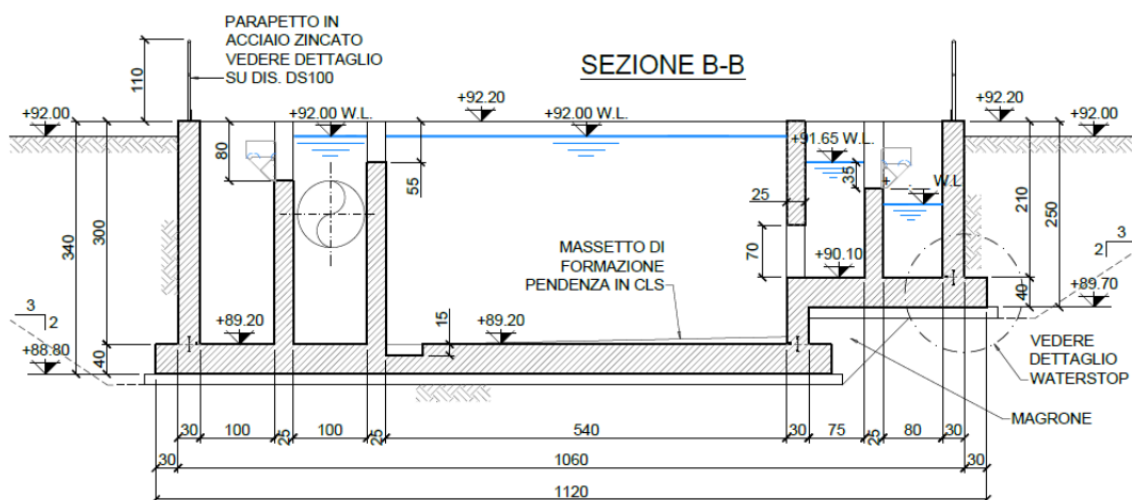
FILTRAZIONE FINALE - SEZIONE B-B
